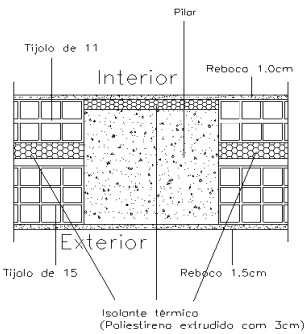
Corte da parede exterior em zona de ponta térmica plana do pilar da solução C
